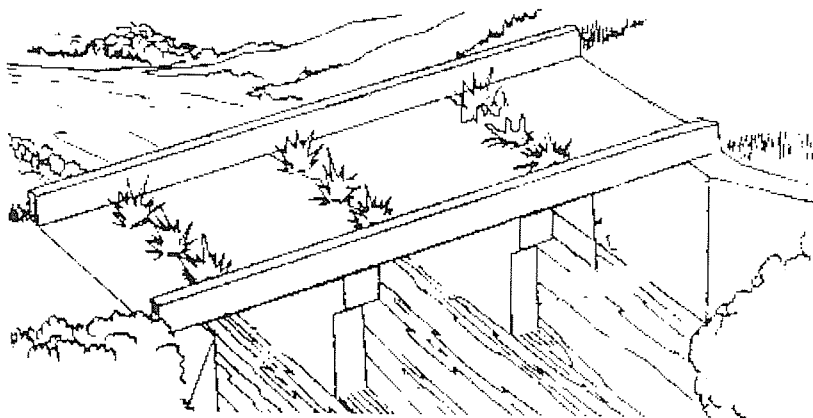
Destrucción de un puente de tramos continuos con estructura de losa de hormigón
